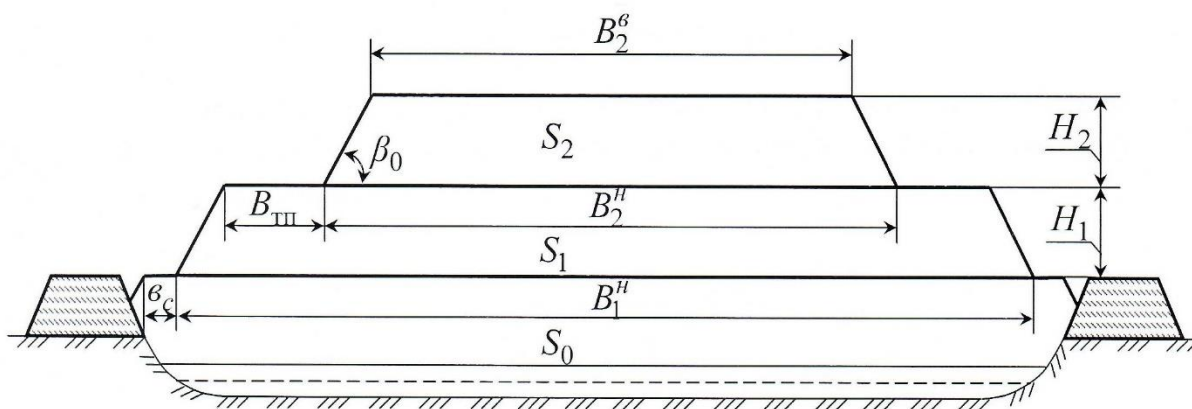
Схема к расчету ритмичности отвалообразования на неустойчивое основание по ярусам
